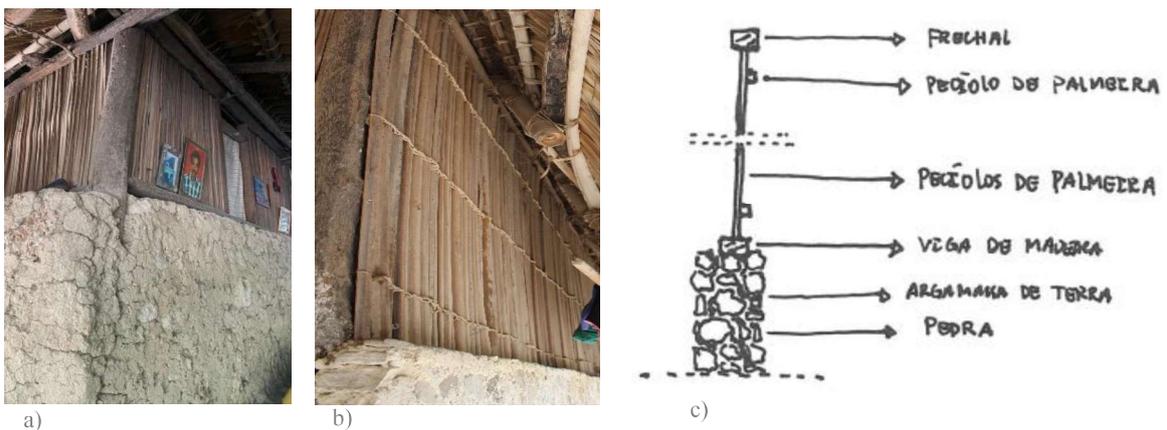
30. Parede mista. a) e b) Parede mista de alvenaria de pedra com palapa c) Desenho em corte da parede.
